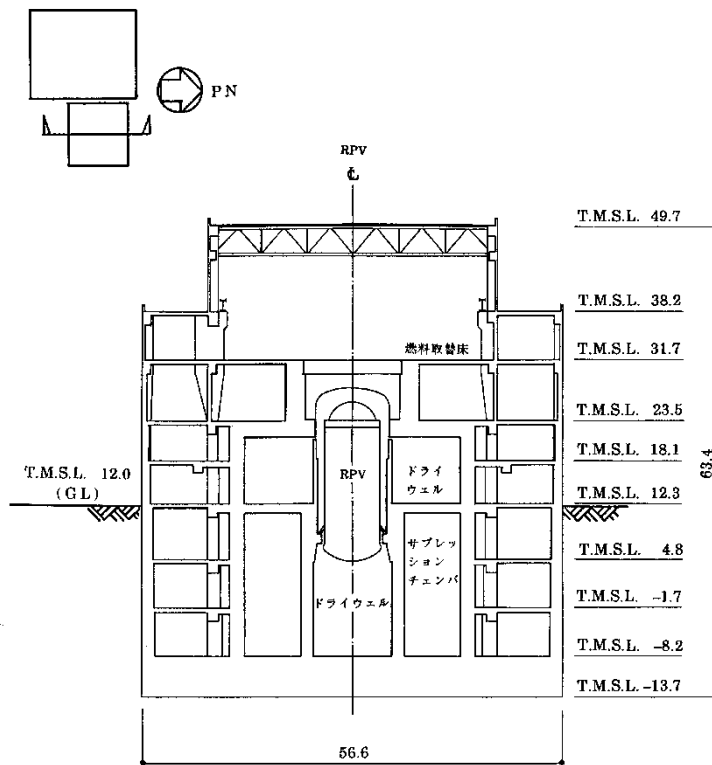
原子炉建屋の概略断面図（単位：m）
